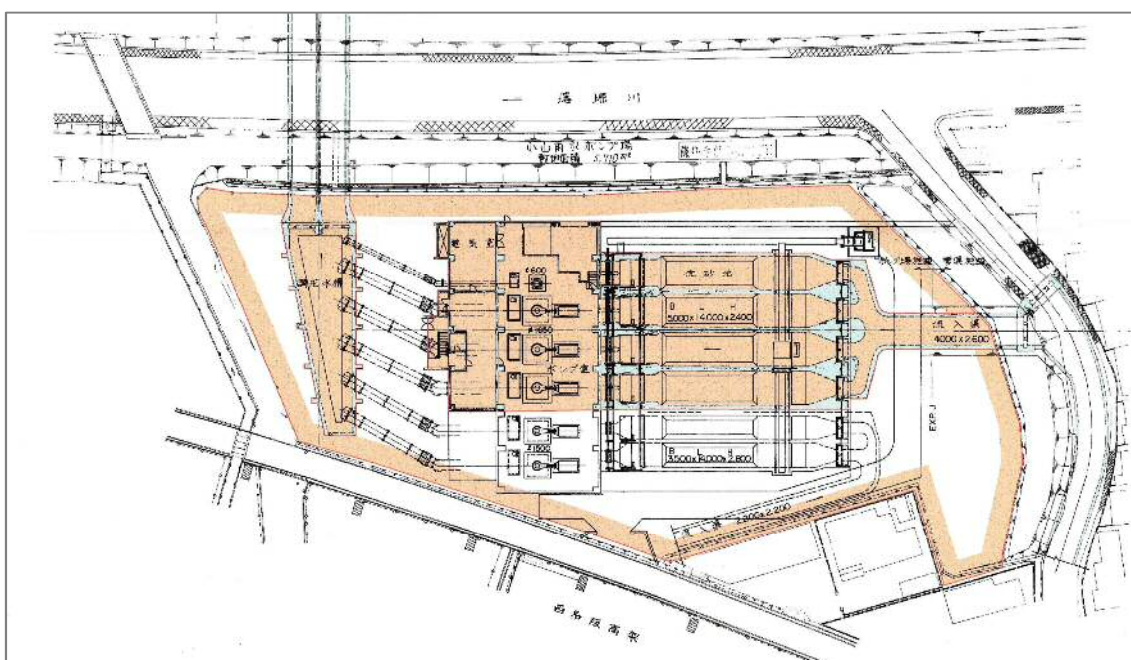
小山雨水ポンプ場平面図 (事業認可)
